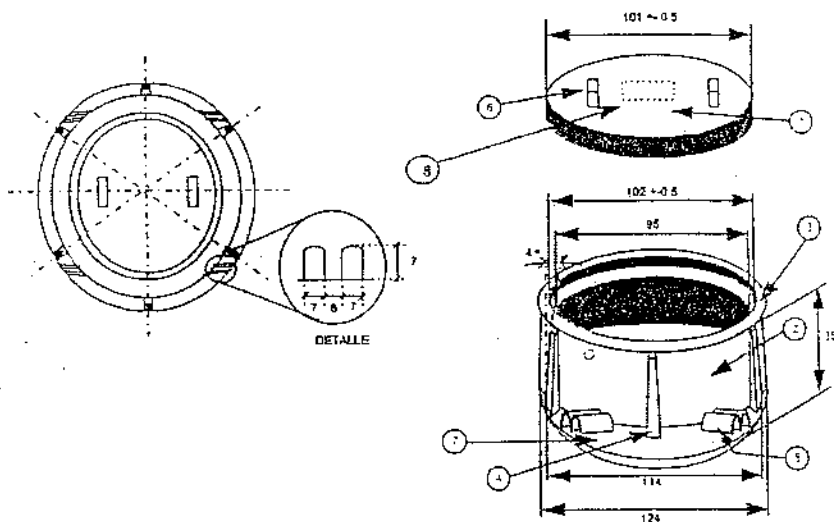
Pozo cónico prefabricado y sus dimensiones.
